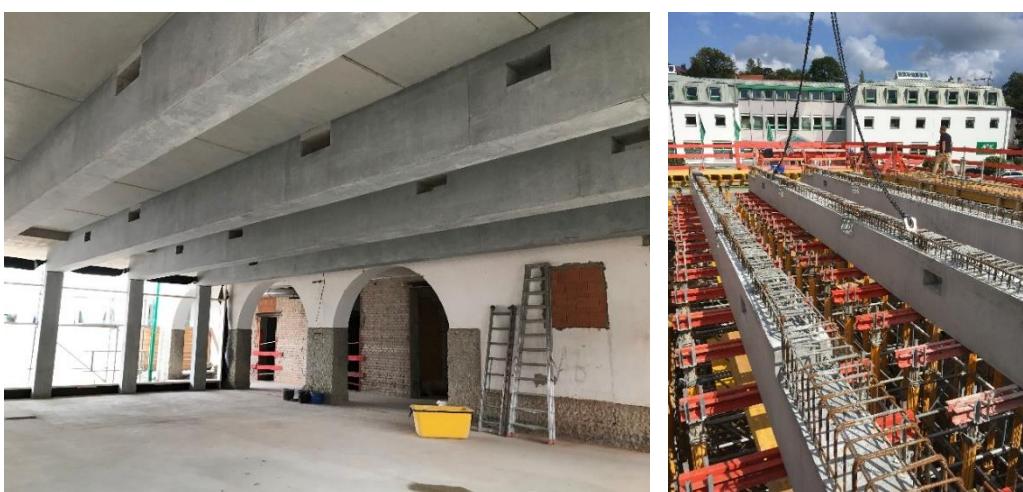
Verbundträger zur Abfangung Obergeschosse in Holzbau – Erweiterung Grundschule Bad Tölz
